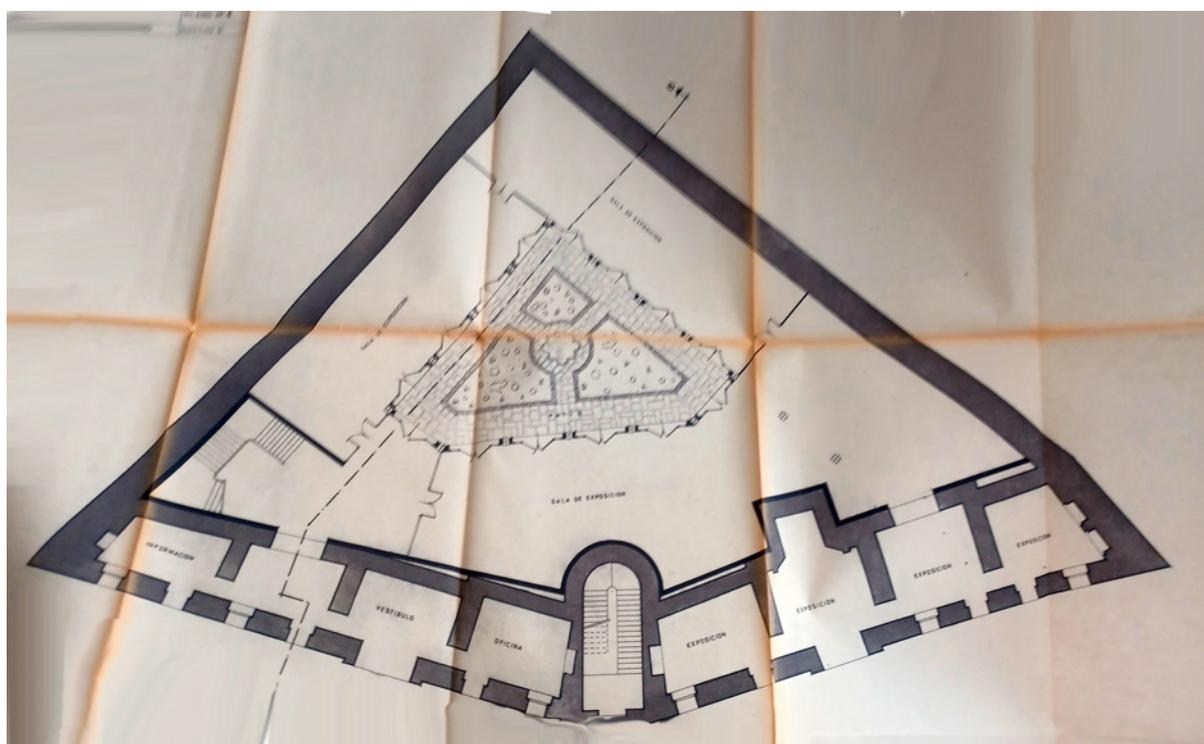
Proyecto Museo Arqueológico, planta baja. Jaime Antón (1982).
